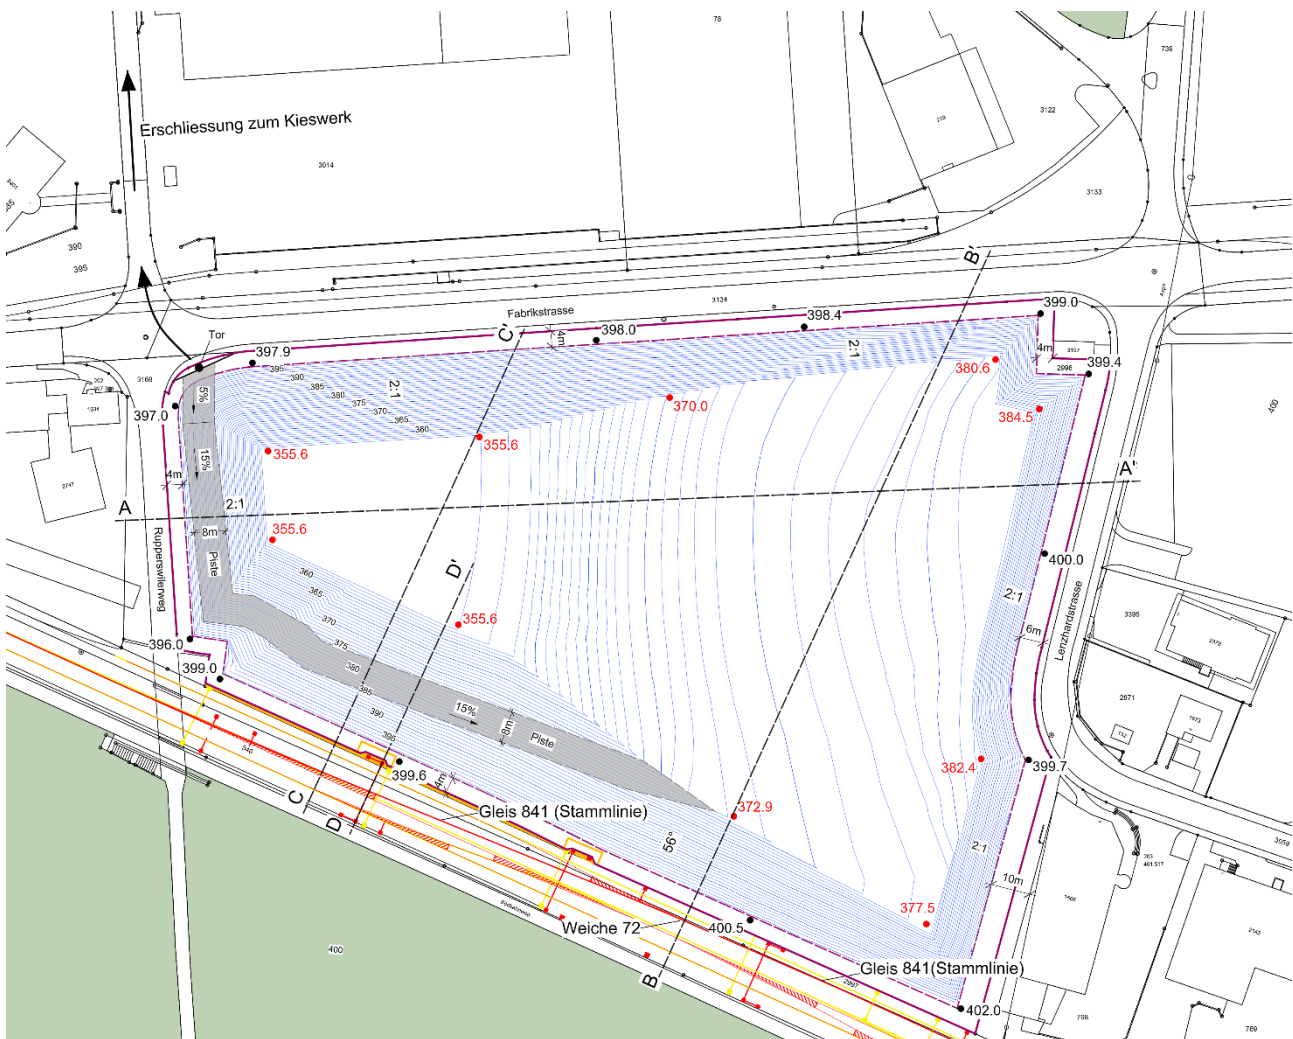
Geplanter Kiesabbau im Projektperimeter
